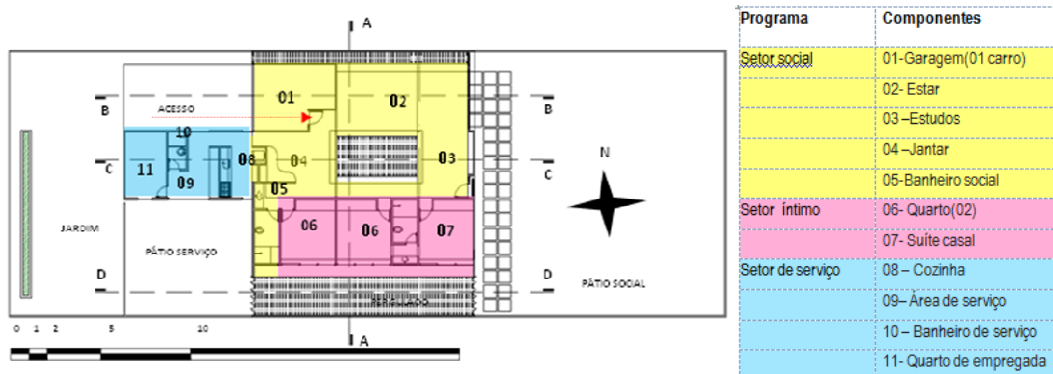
Casa 02 – planta baixa com setores. Fonte: ARCEN/PMJP. Desenho: M.P.Viana, 2008. Edição: Roberta Xavier da Costa, 2011.
